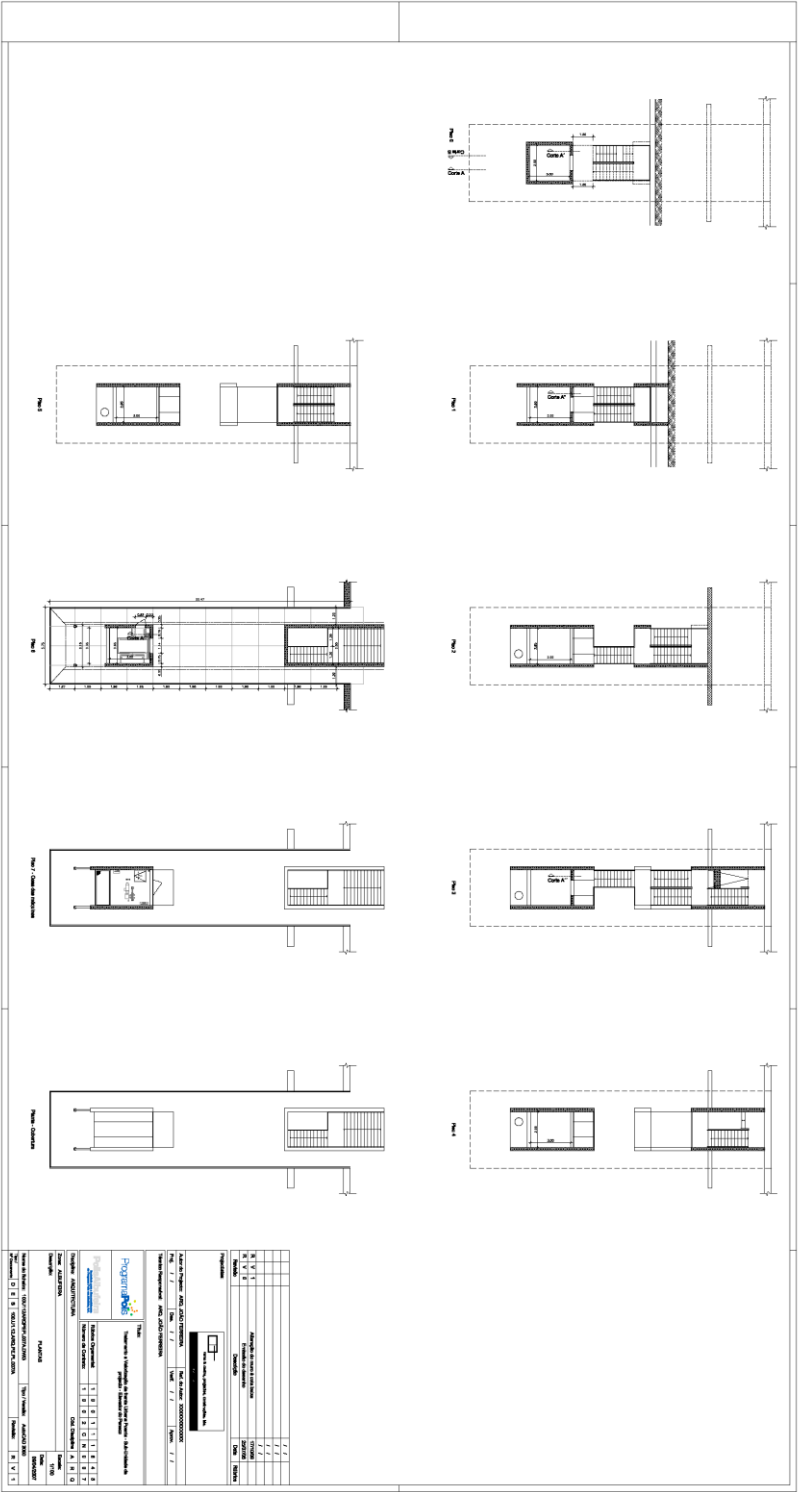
Plantas das escadas nos diferentes pisos. Fonte: Gabinete de arquitetura João Castro Ferreira
